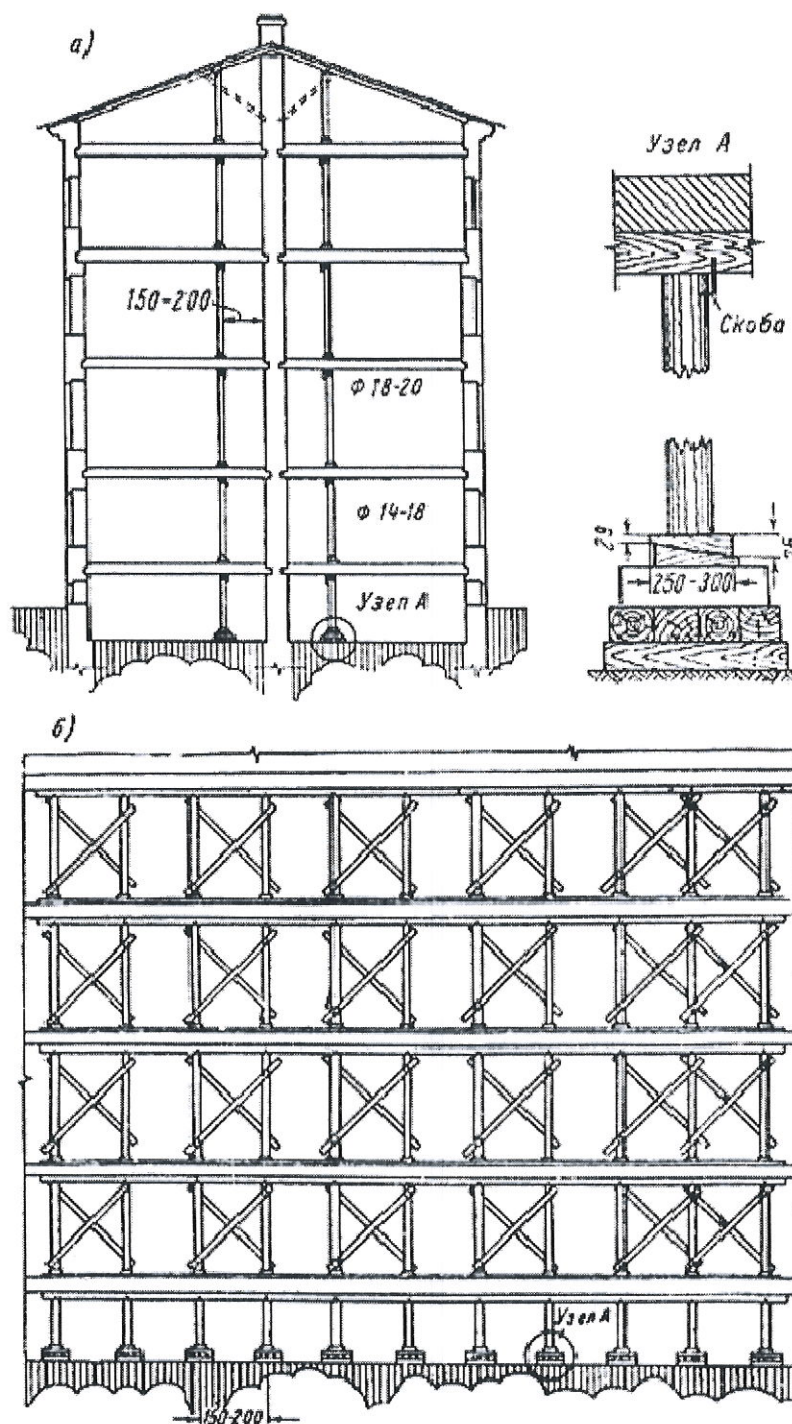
Установка временных креплений при перекладке участка средней продольной стены с сохранением существующих перекрытий
